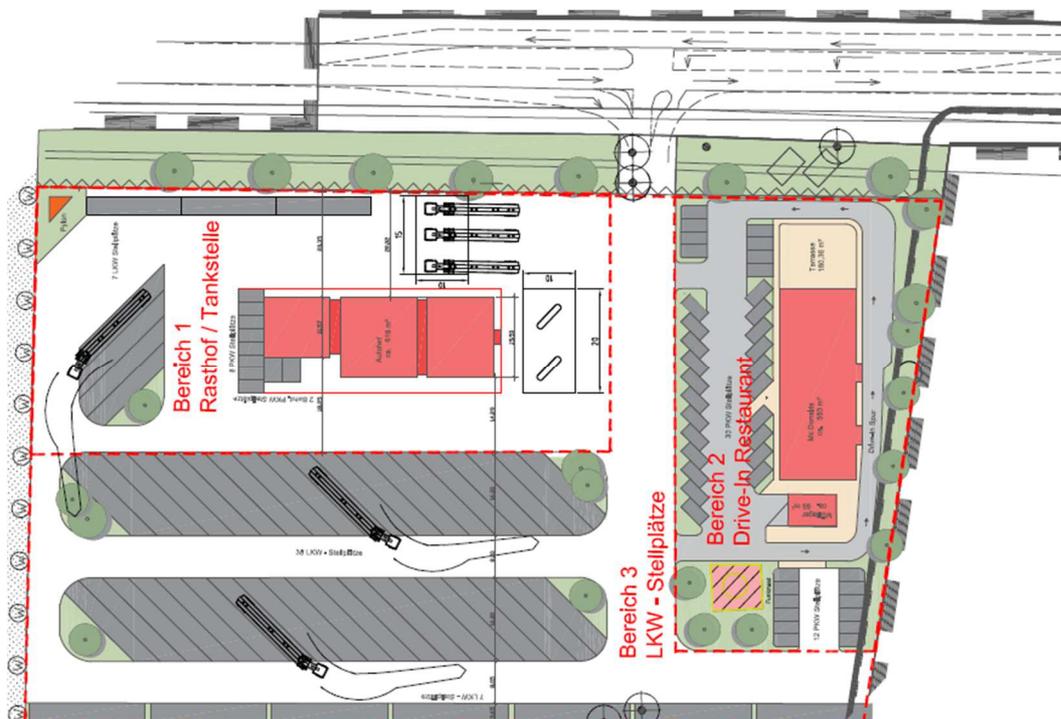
Ausschnitt Lageplan Autohof Grabow (Quelle: ppb Oldenburg)
